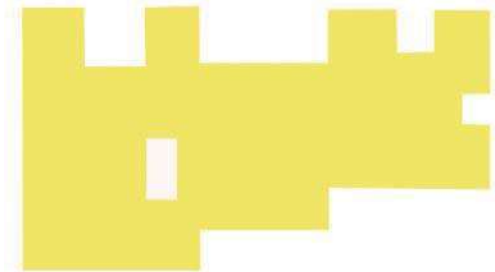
Planta Arquitectónica, muestra la integración de los tres rectángulos.
